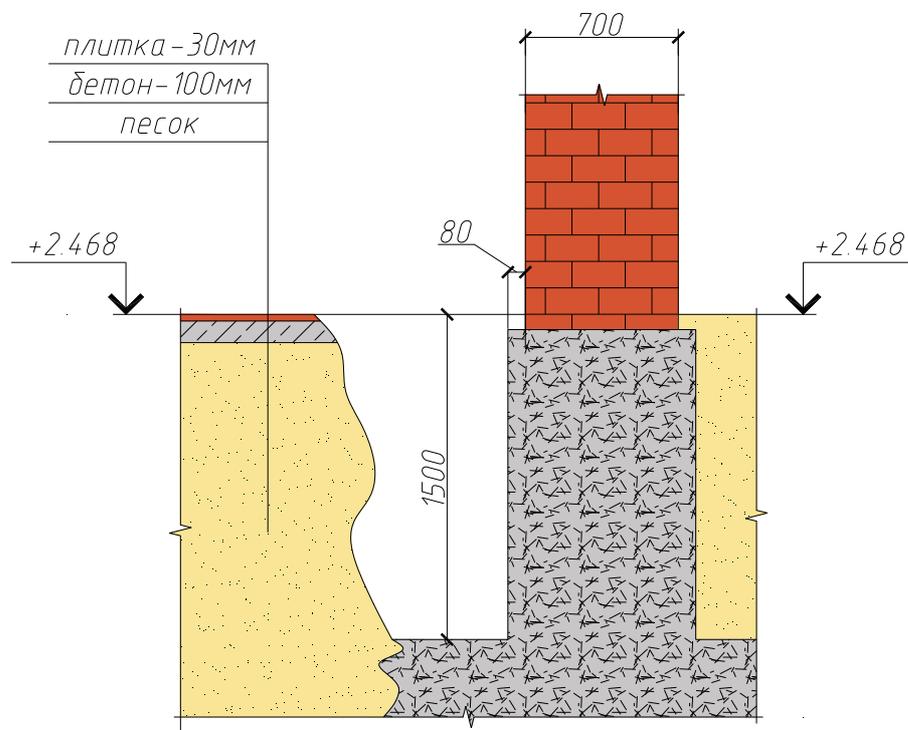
Эскиз поперечного сечения фундамента.
